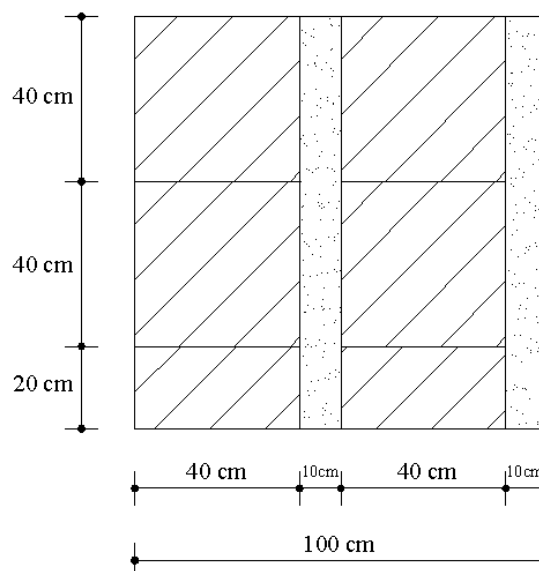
Esquema de 1 m² de Losa Unidireccional
